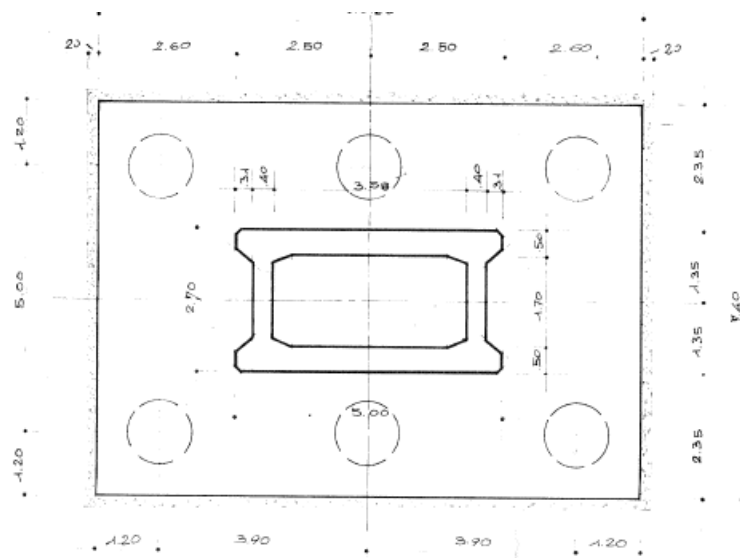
Pianta della fondazione con indicazione dei pali, 6 pali
